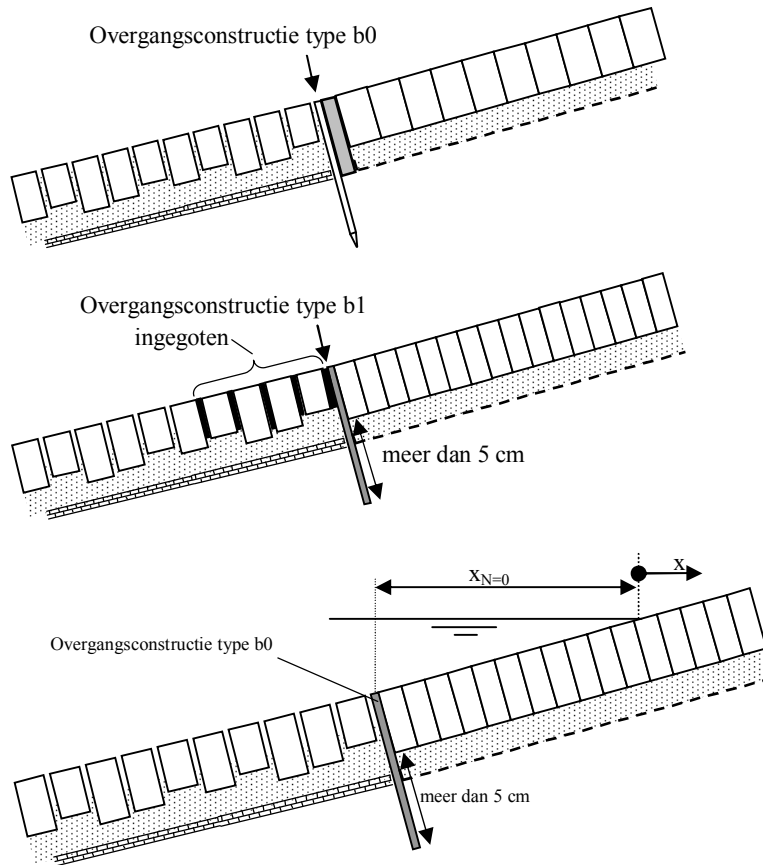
Naamgeving van relevante overgangsconstructies m.b.t. klemming
